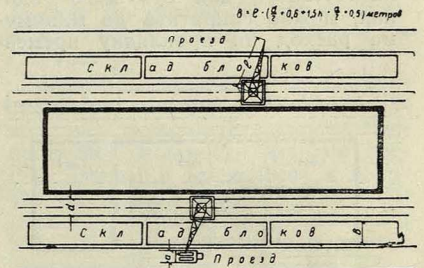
складочная площадка для блоков при монтаже здания краном «Красный металлист»
